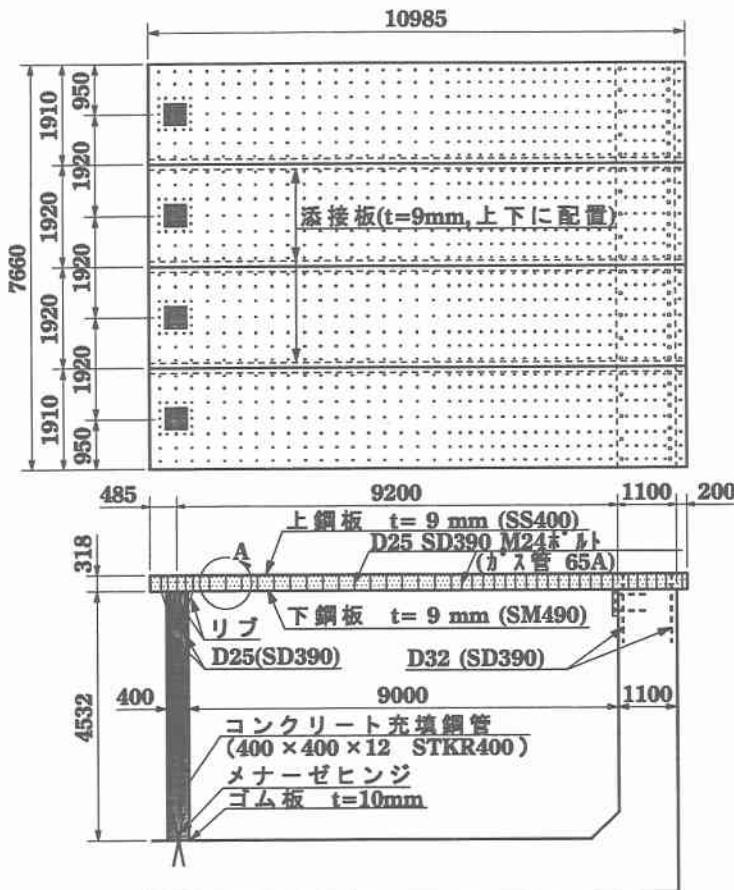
サンドイッチ覆道形状寸法 (単位: mm)
